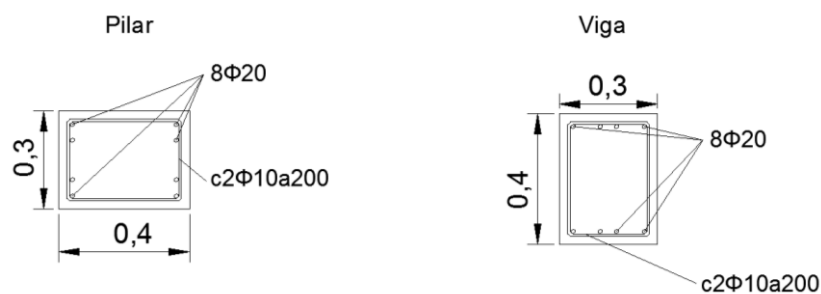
Detalle del armado de las secciones del pórtico de un piso considerado
